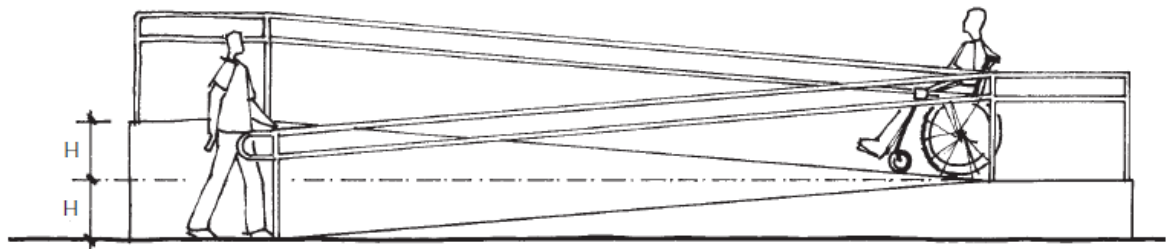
Vista lateral da rampa (SMPED, 2008).
